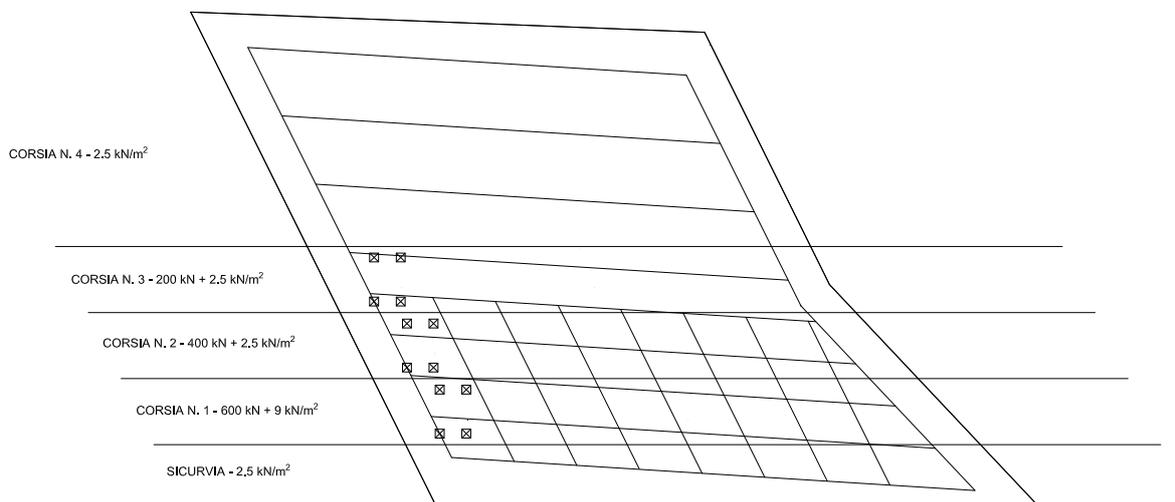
Disposizione carico tandem per massimo taglio impalcato di progetto
